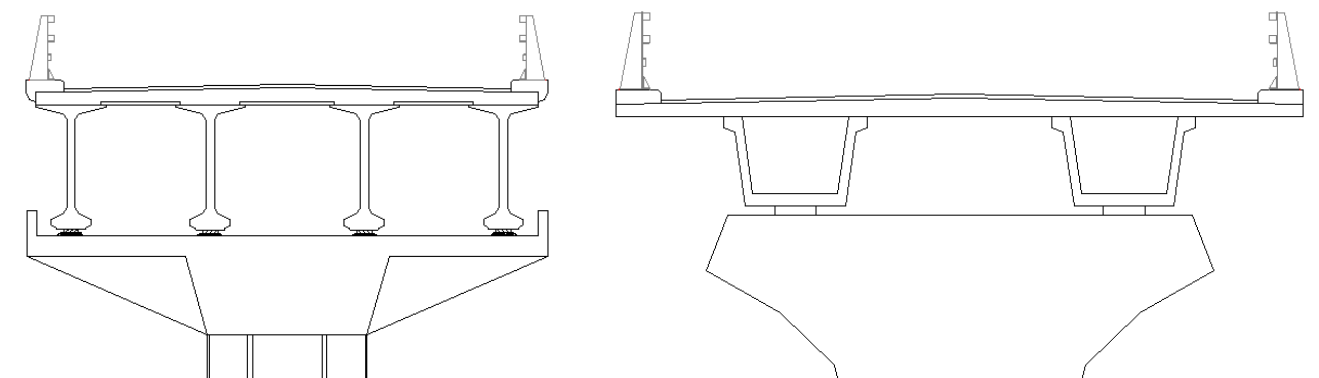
Puente vigas prefabricadas en doble T y en artesa. Secciones tipo
